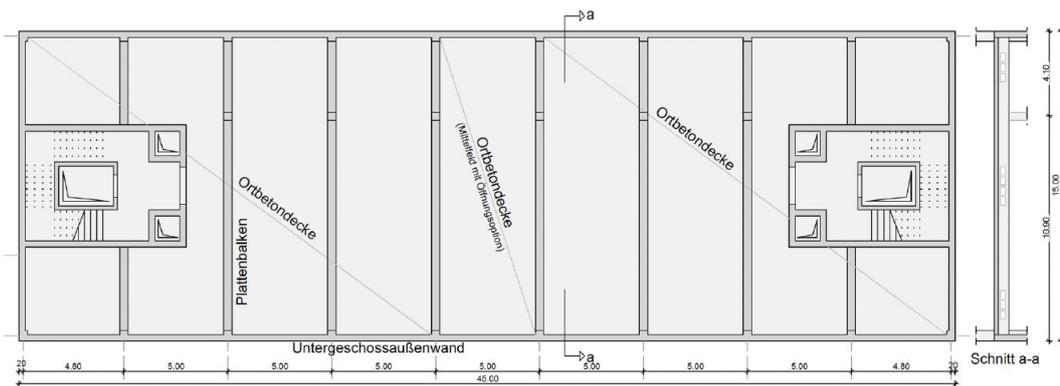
Deckenuntersicht Decke über UG (Unterzugsdecke in Ortbetonbauweise)
